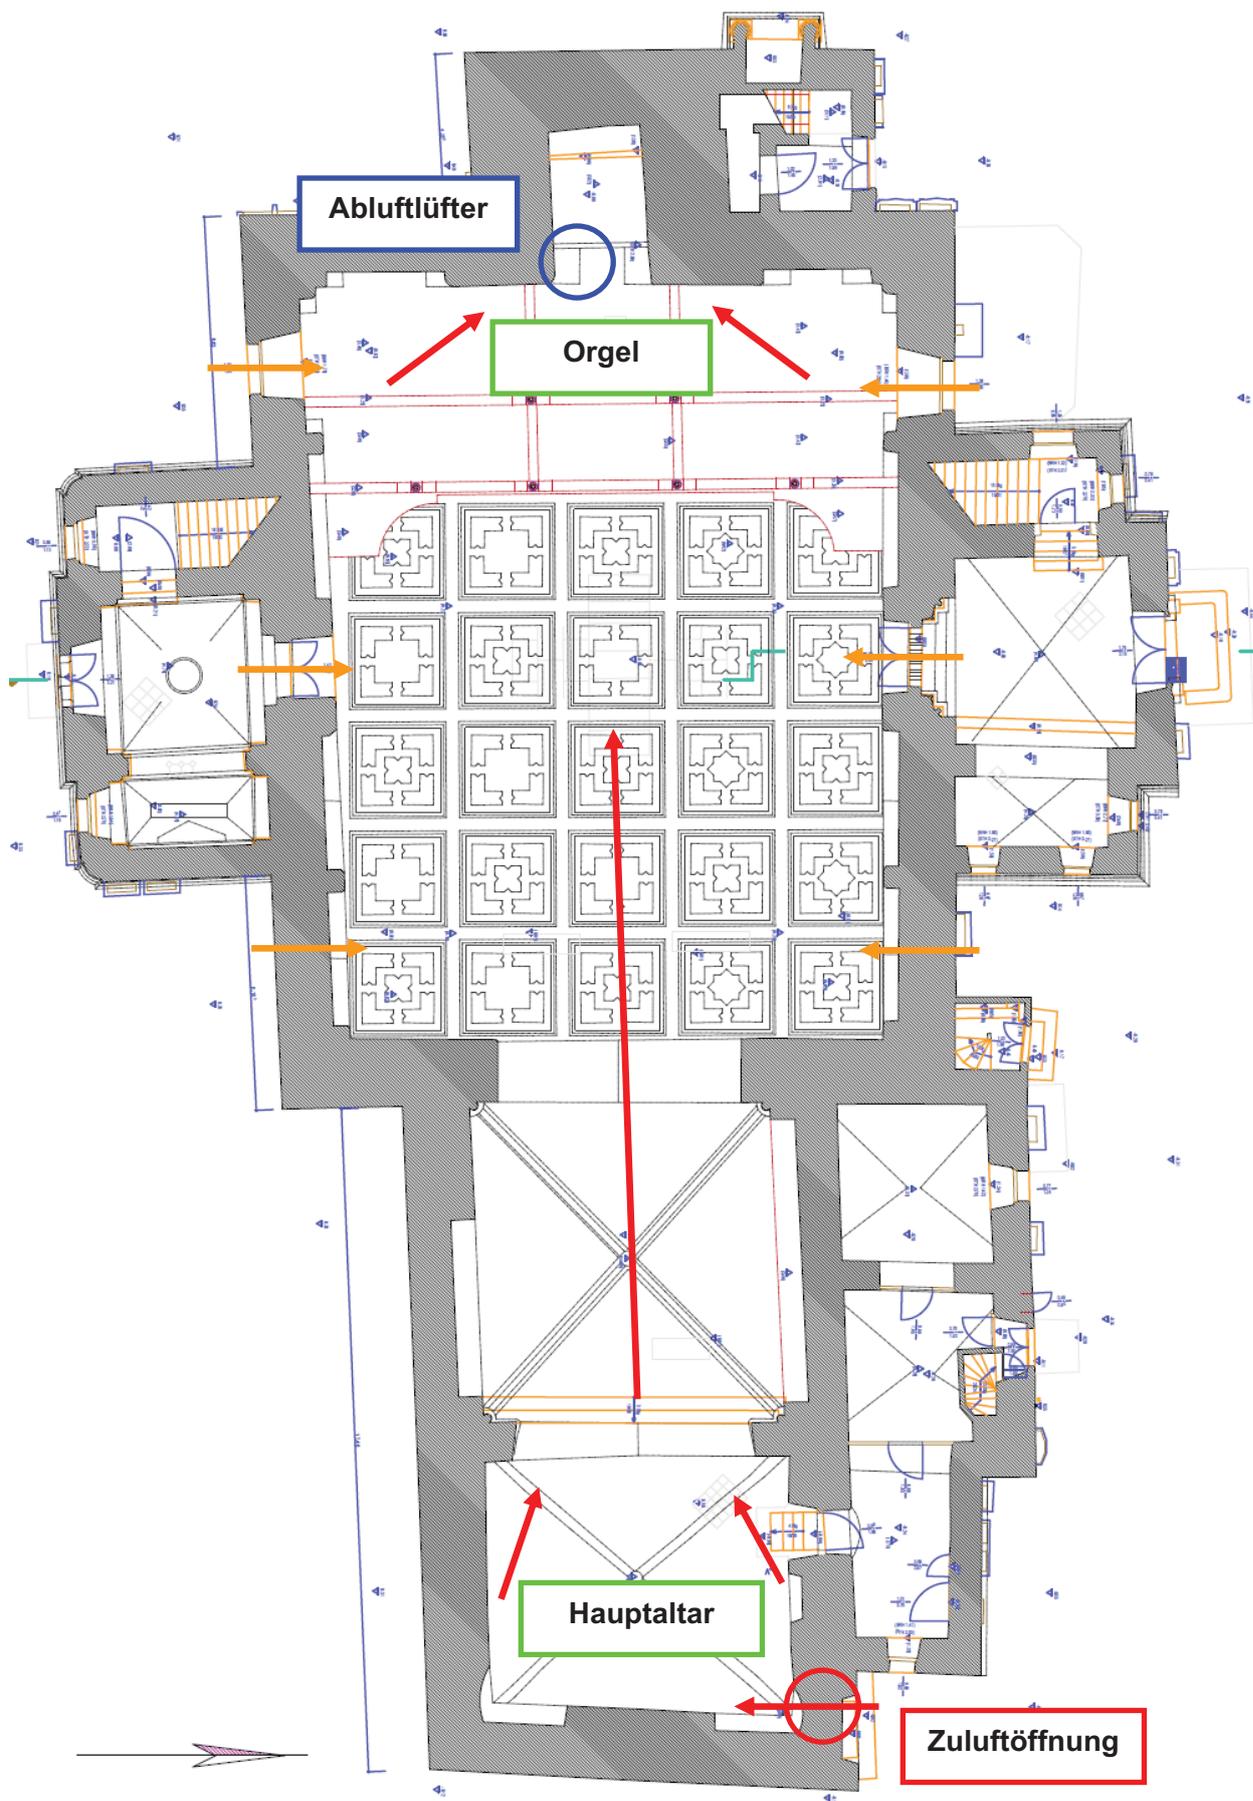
Grundriss der Pfarrkirche „Mariä Himmelfahrt, Ostritz
